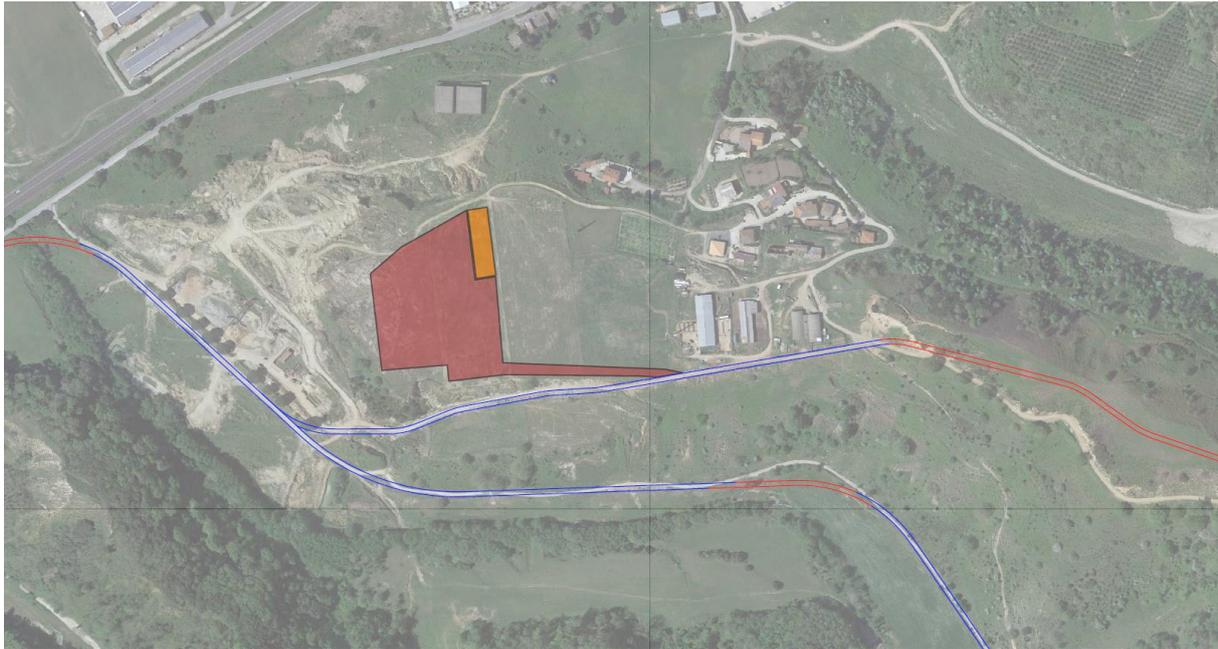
Ubicazione area logistica di cantiere e Area stoccaggio terre e rocce da scavo
